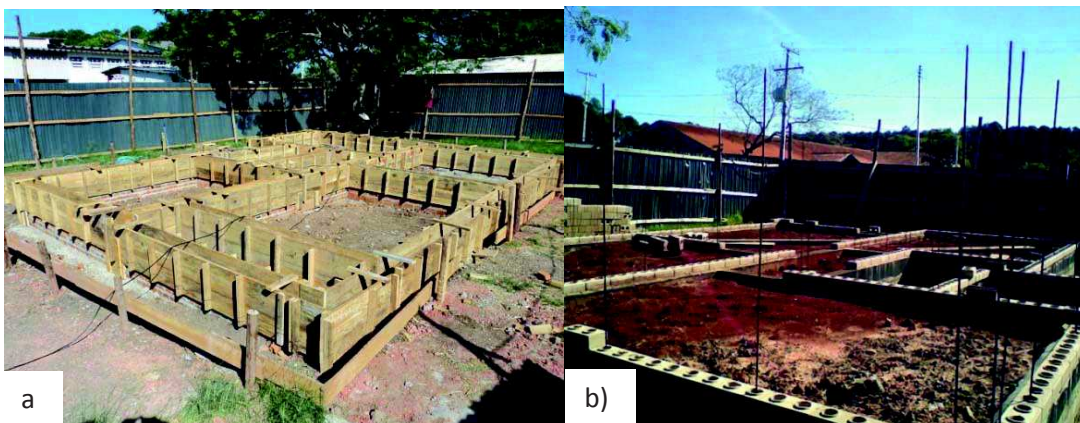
a) Vigas de fundação; b) Primeira fiada de alvenaria de solo cimento.
